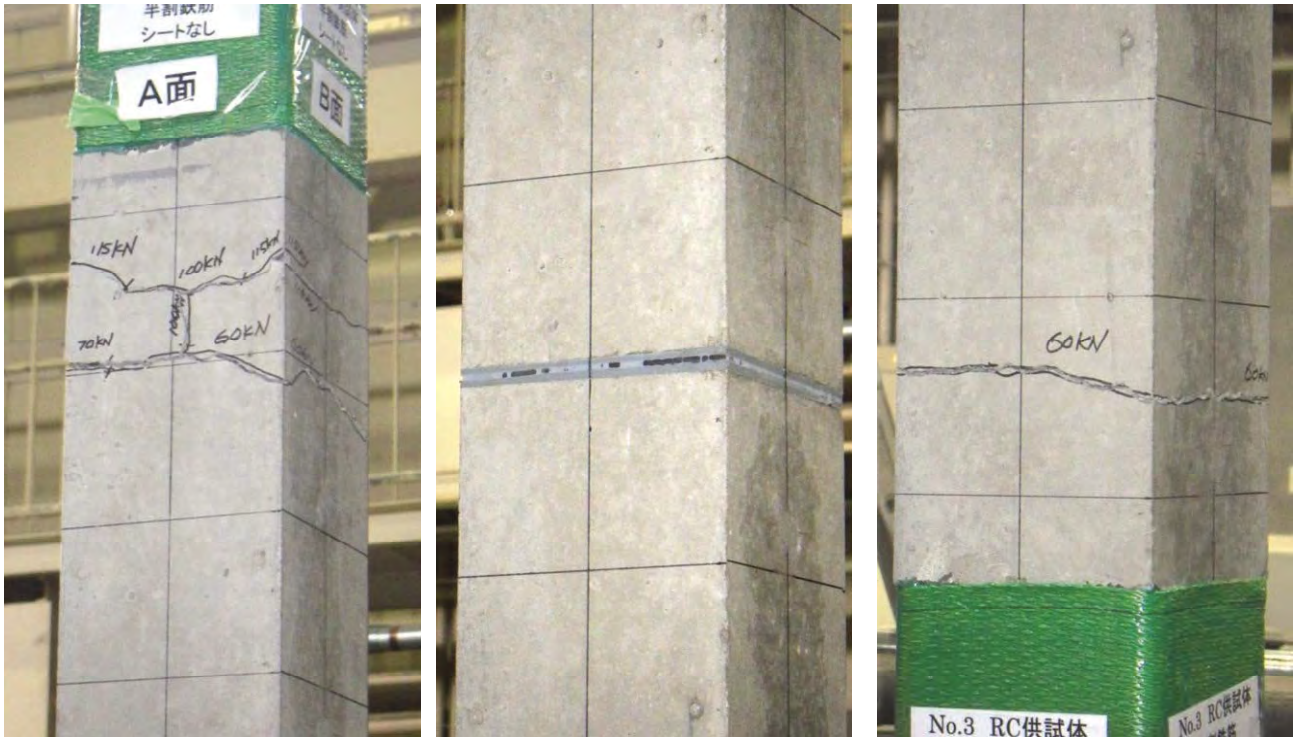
鉄筋降伏時におけるコンクリートのひび割れ発生状況 (つづき)
